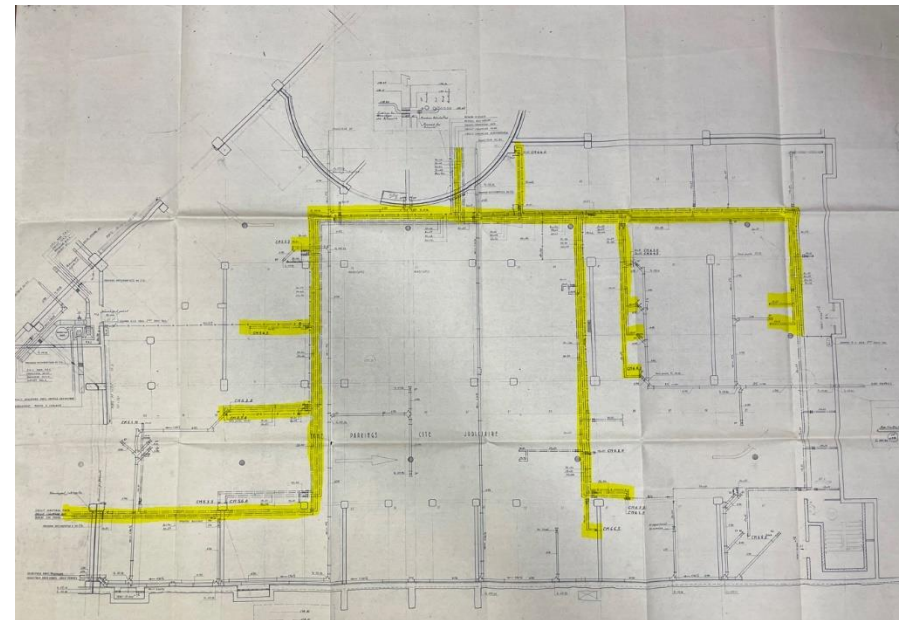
PLAN SOUS-SOL BLOCS 5 & 6 : RESEAUX DE CHAUFFAGE (EN JAUNE)
